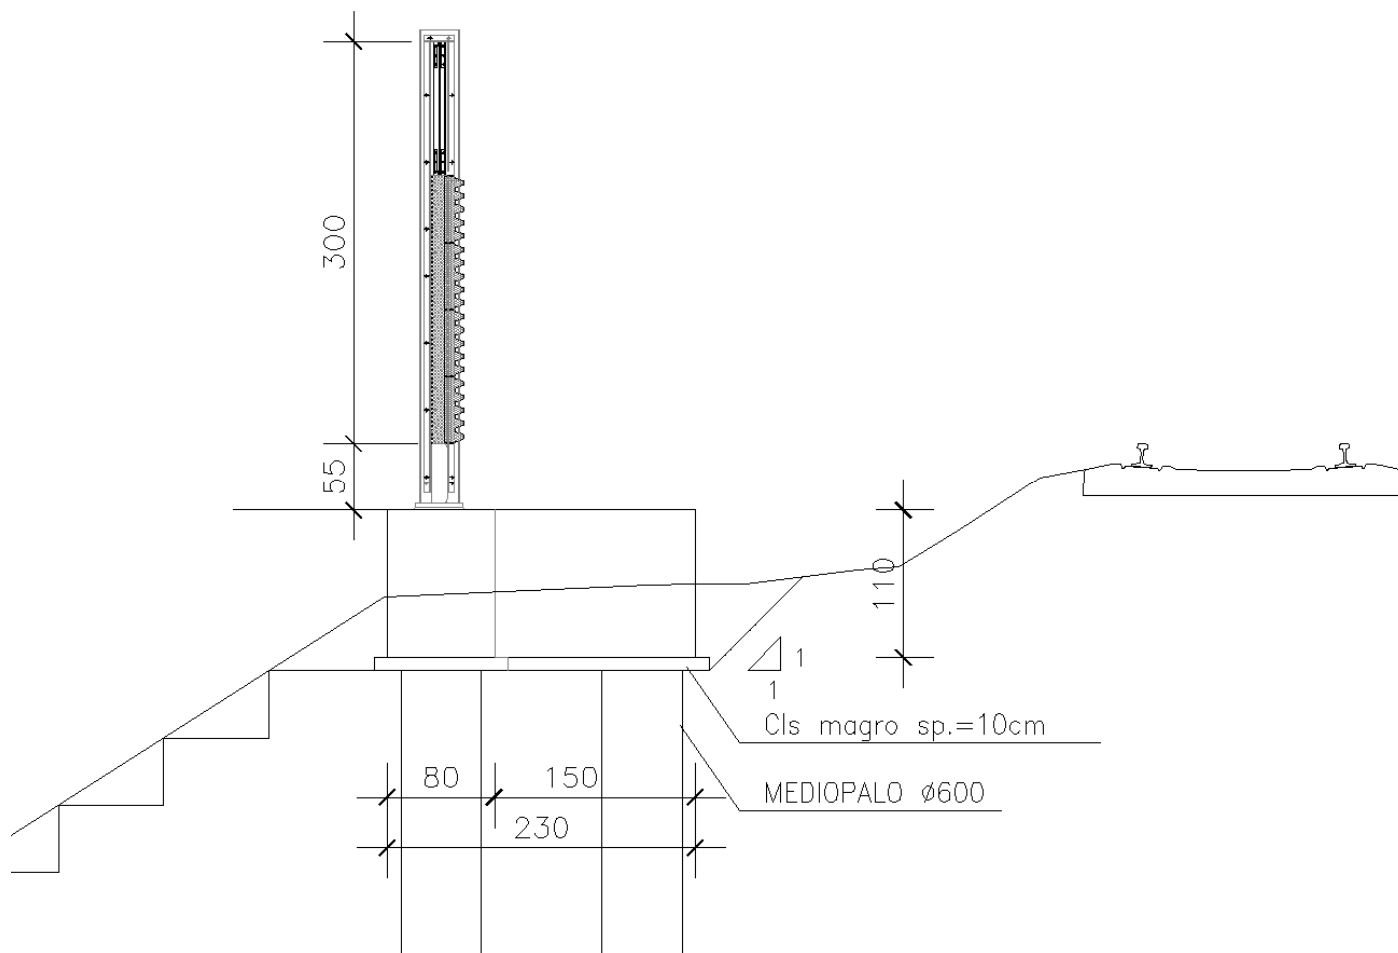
Fondazione scavalco L= 10.40 m - Sezione
